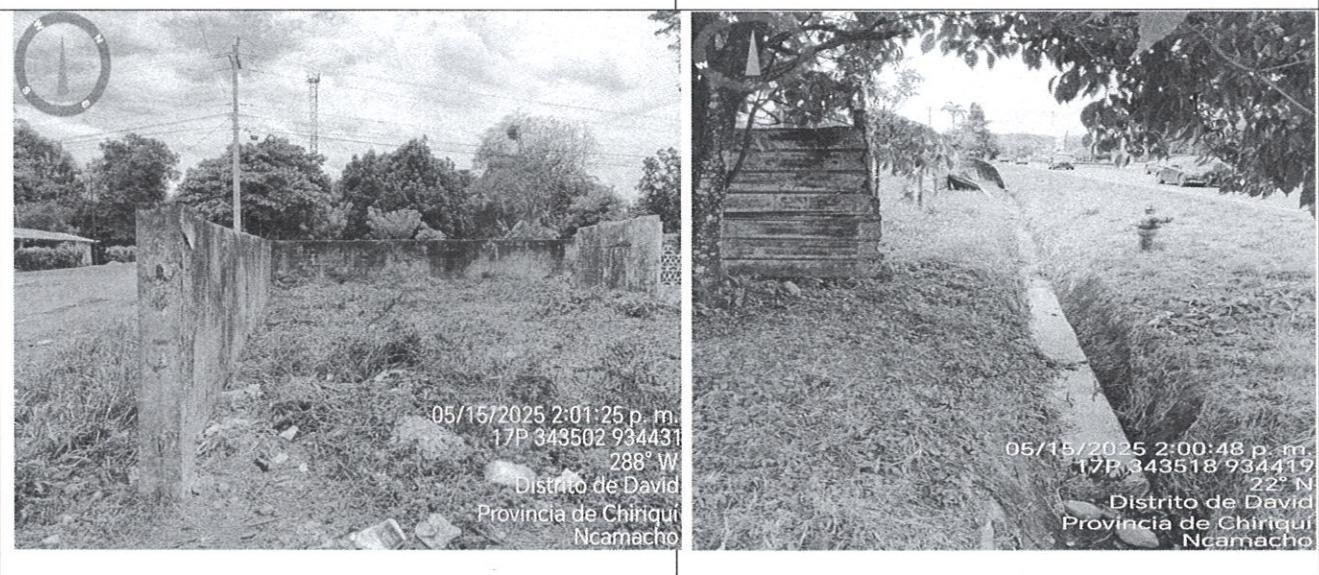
Vista de la tapia de existente y la estructura a demoler..
